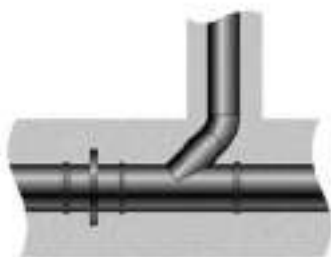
Fissaggio nel calcestruzzo con una colletto di fissaggio.
